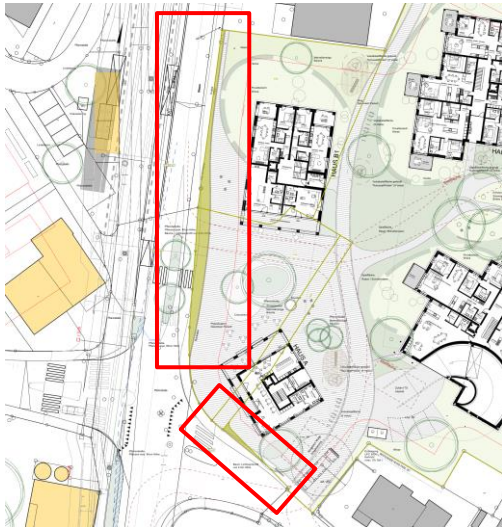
Auszug Situation Vorprojekt, Umbau Bahnhof und Hauptstrasse Hirschtal, 16.09.2022, BVU und AVA
